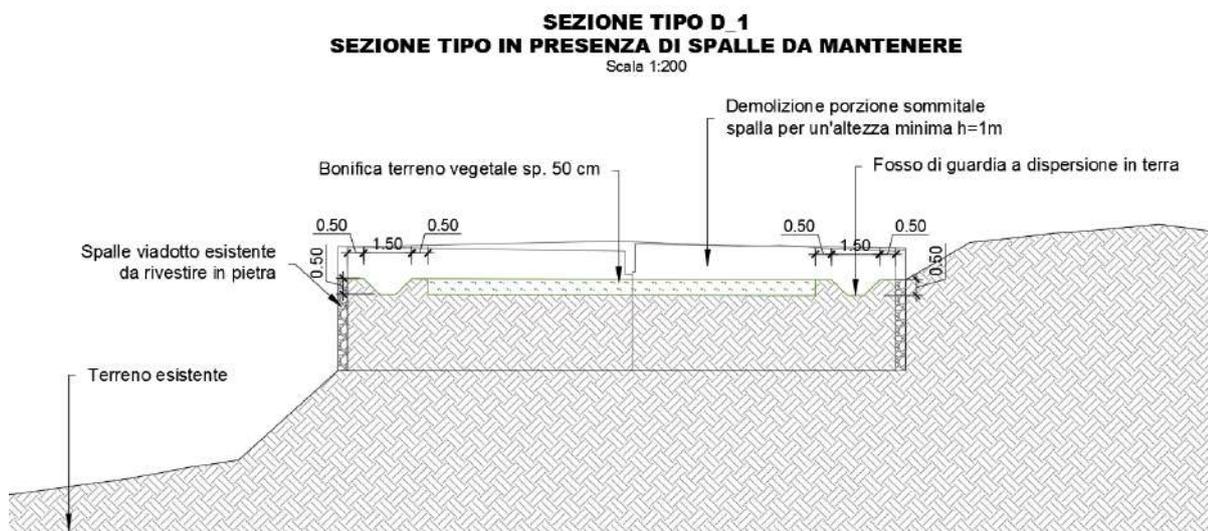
Sezione tipo D_1 in presenza di spalle da mantenere
